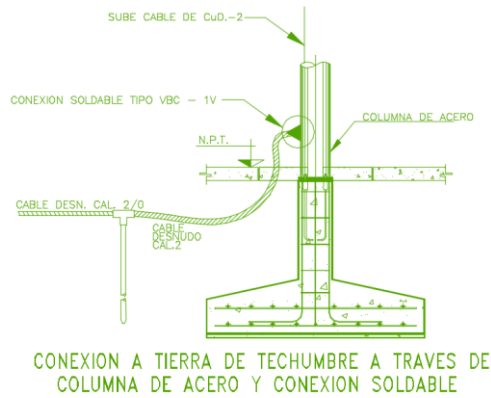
Detalle de conexión a tierra de techumbre a través de columna de acero y conexión soldable.
